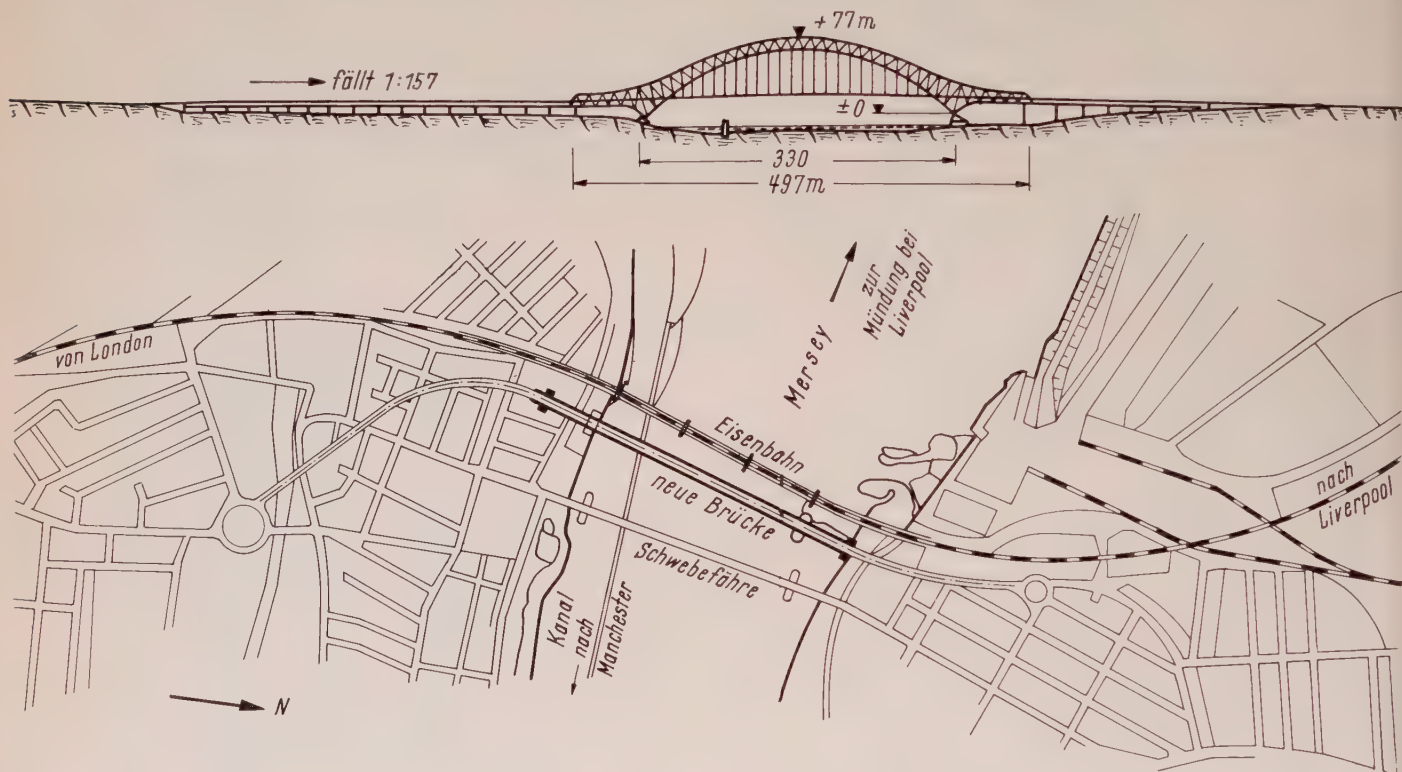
Allgemeiner Lageplan und Ansicht der Runcorn-Widnes-Brücke
